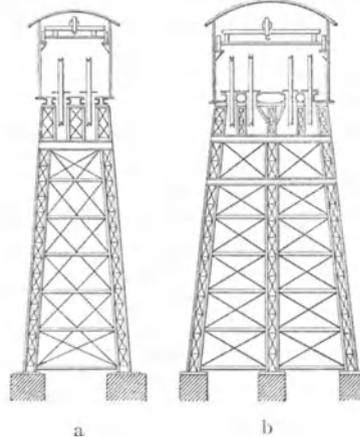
a und b. Vorderansicht von Stahl-Fördergerüsten.
